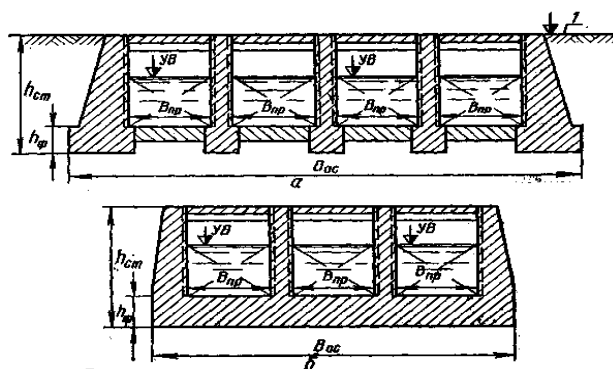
Примыкание устоев и быков к флютбету:
